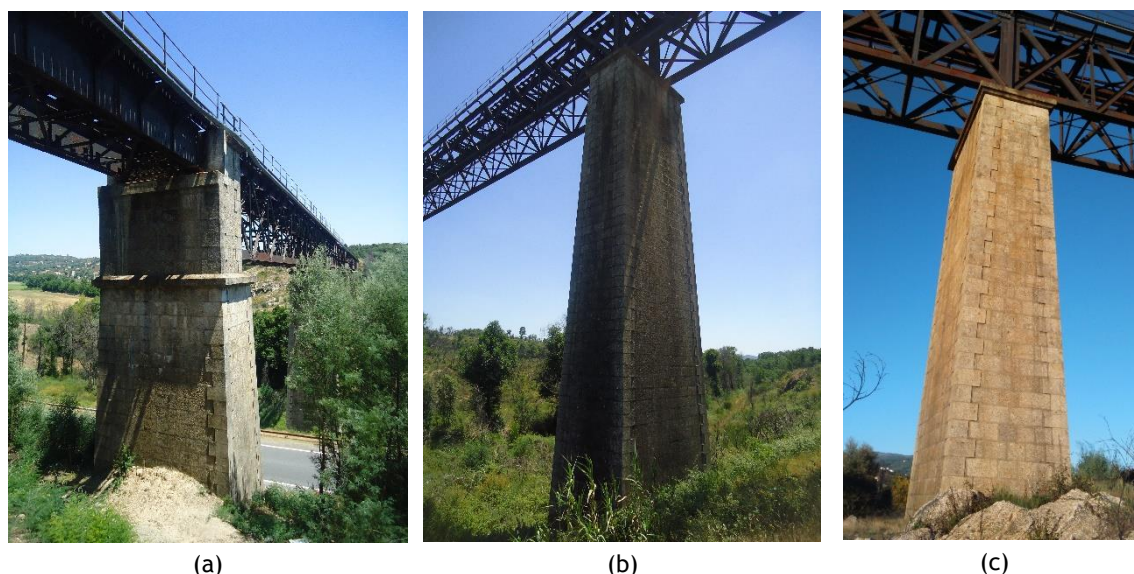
Vista dos pilares de alvenaria: (a) Pilar Estribo - P1; (b) P2 - Altura de 25,0 m; (c) P4 - Altura de 16,0 m
